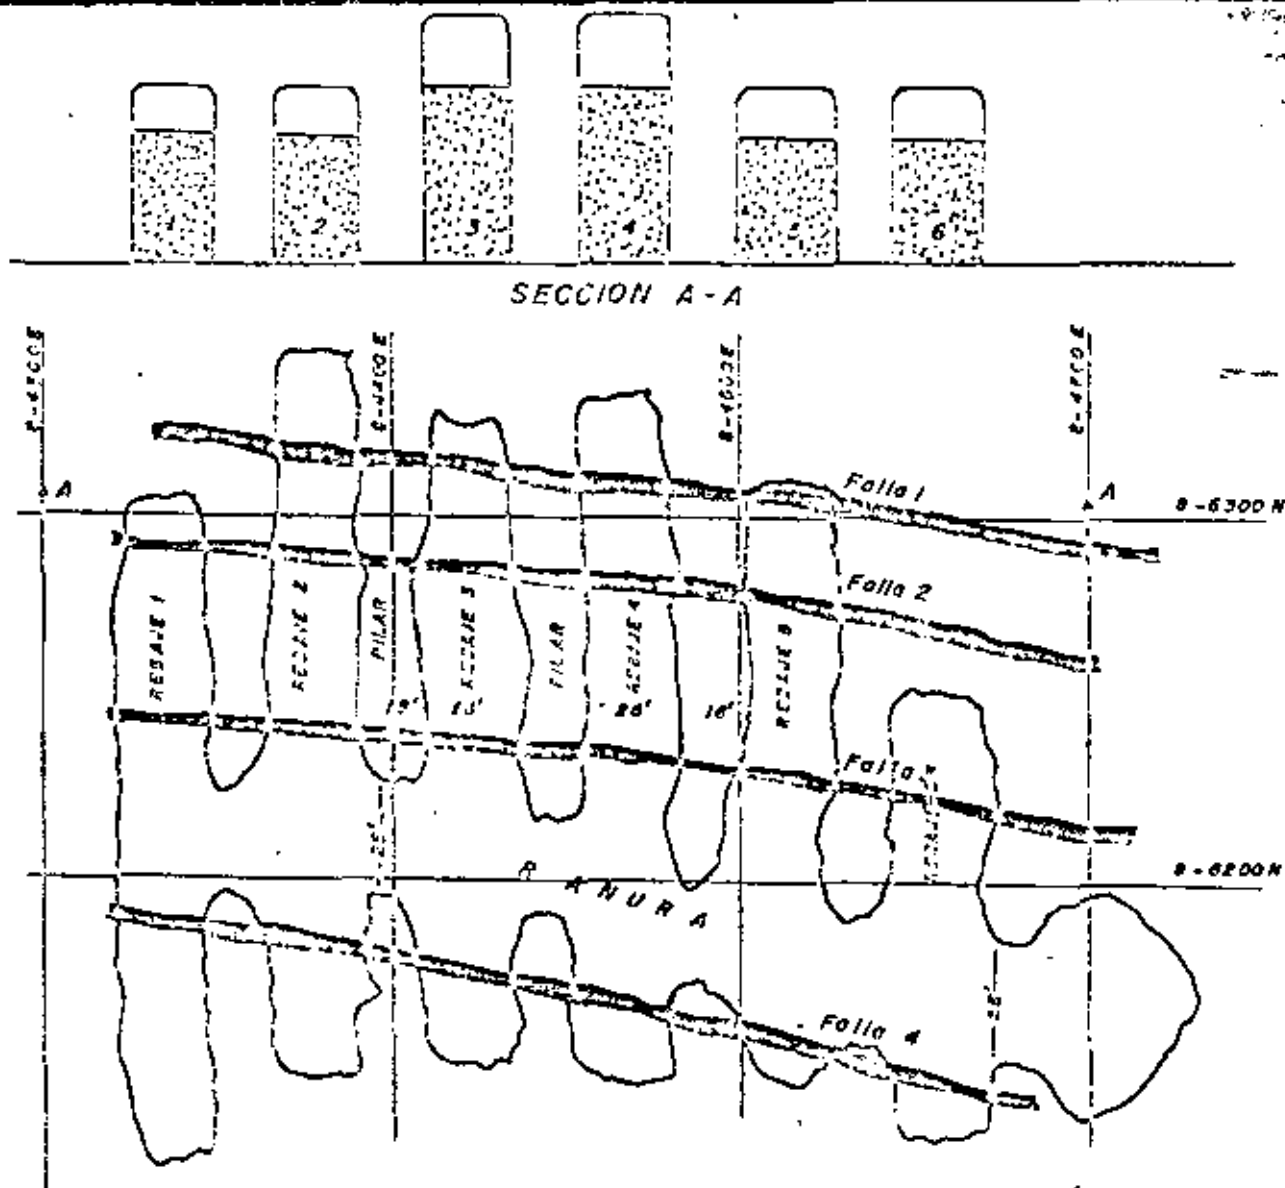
PLANTA Y SECCION MOSTRANDO SISTEMA DE CORTE Y RELLENO MECANIZADO (DIB PILLARS). NOTE QUE EL AVANCE DEL TUMBE SE EN DIRECCION NORMAL AL SISTEMA DE FALLAS.
